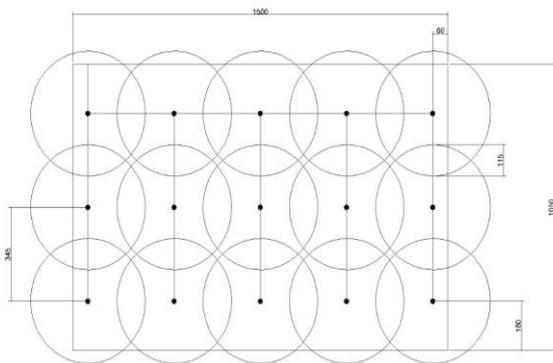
Peletakkan *Sprinkler* di Ruang Terapi, Ruang Pembelajaran, dan Ruang Bahasa Isyarat
